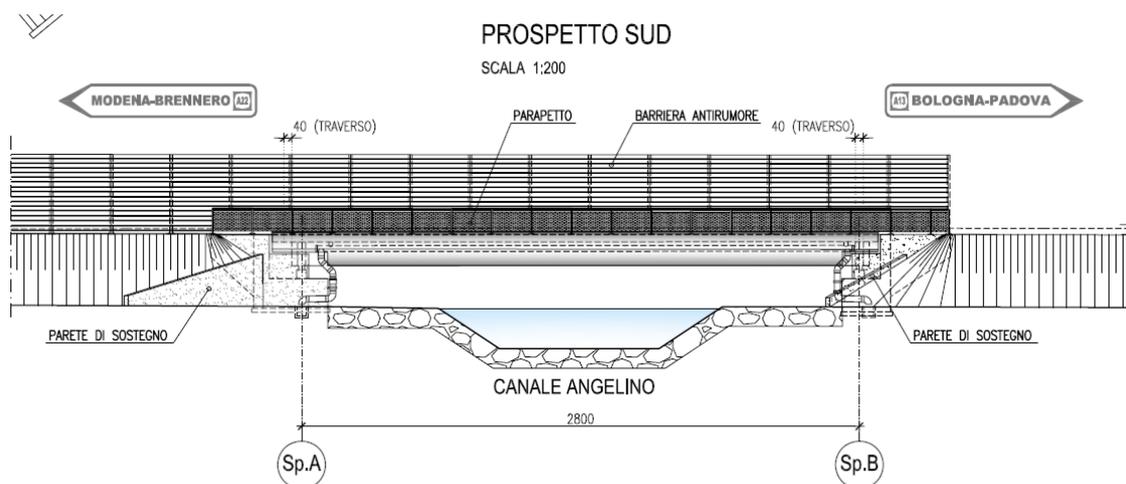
A – PROSPETTO DEL PONTE SUL CAVO ANGELINO (PD)
